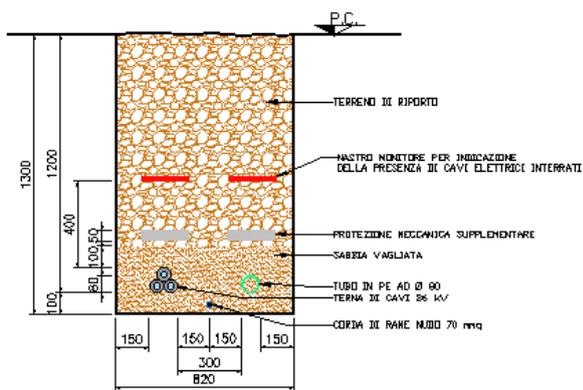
Planimetria cavidotti su CTR e Sezioni tipo
